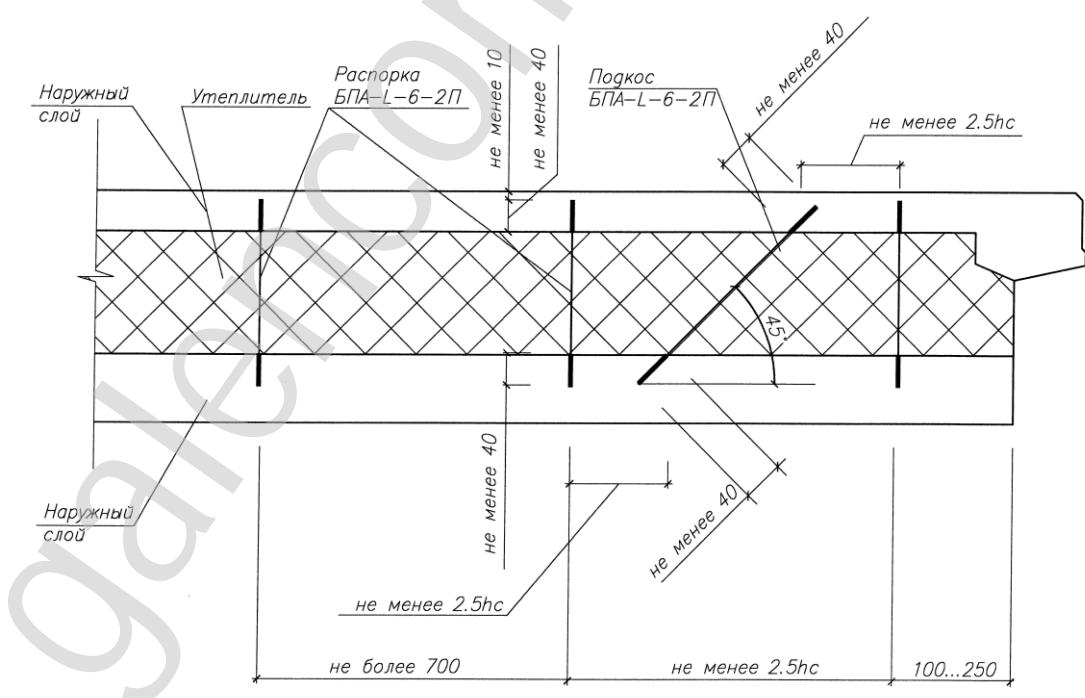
Трехслойная железобетонная панель. Горизонтальный разрез.
